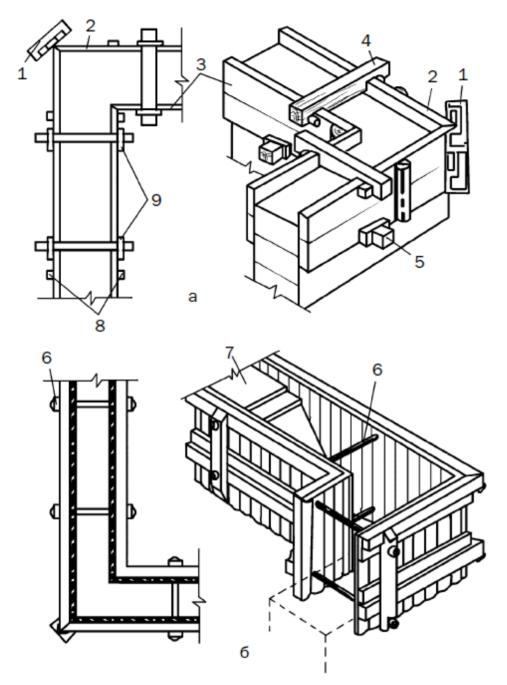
Устройство передвижной опалубки для изготовления монолитной стены: а — из горизонтальных щитов с деревянными перемычками-стяжками; б — из вертикальных щитов с металлическими стяжками; 1 — струбцина; 2 — наружный щит; 3 — внутренний щит; 4 — верхняя стяжка; 5 — нижняя стяжка; 6 — металлическая стяжка; 7 — легкий бетон; 8 — вертикальный брус; 9 — клинья
